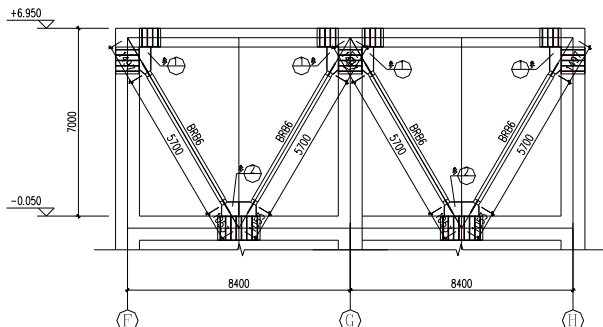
轴④处轴①和轴②间屈曲约束支撑布置立面图
